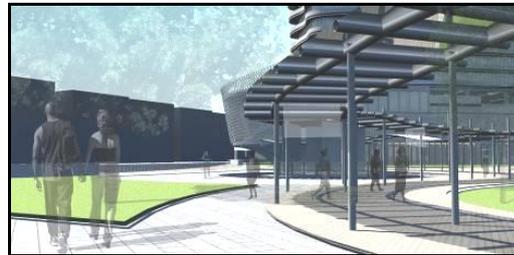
Pengembangan Ketiga Fasad Bangunan Hotel dan Apartemen
